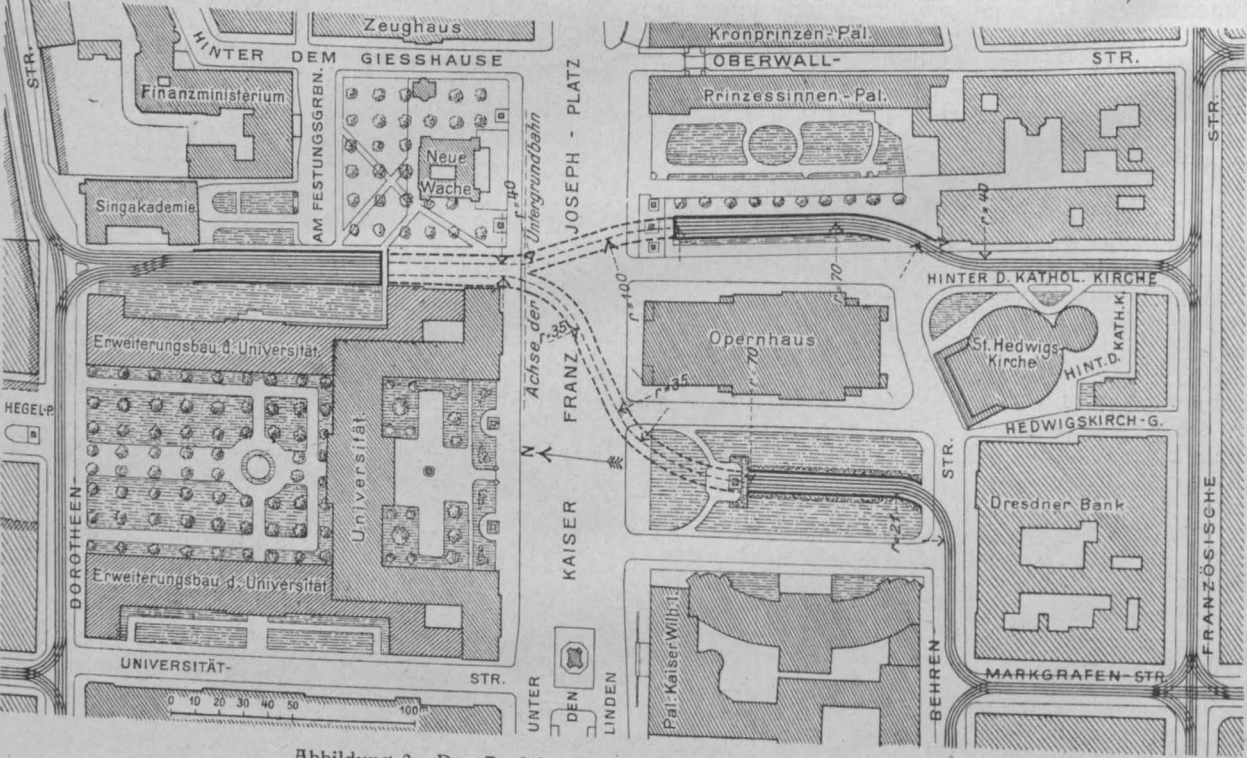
Der Ausführung entsprechender Lageplan (1:3000).
